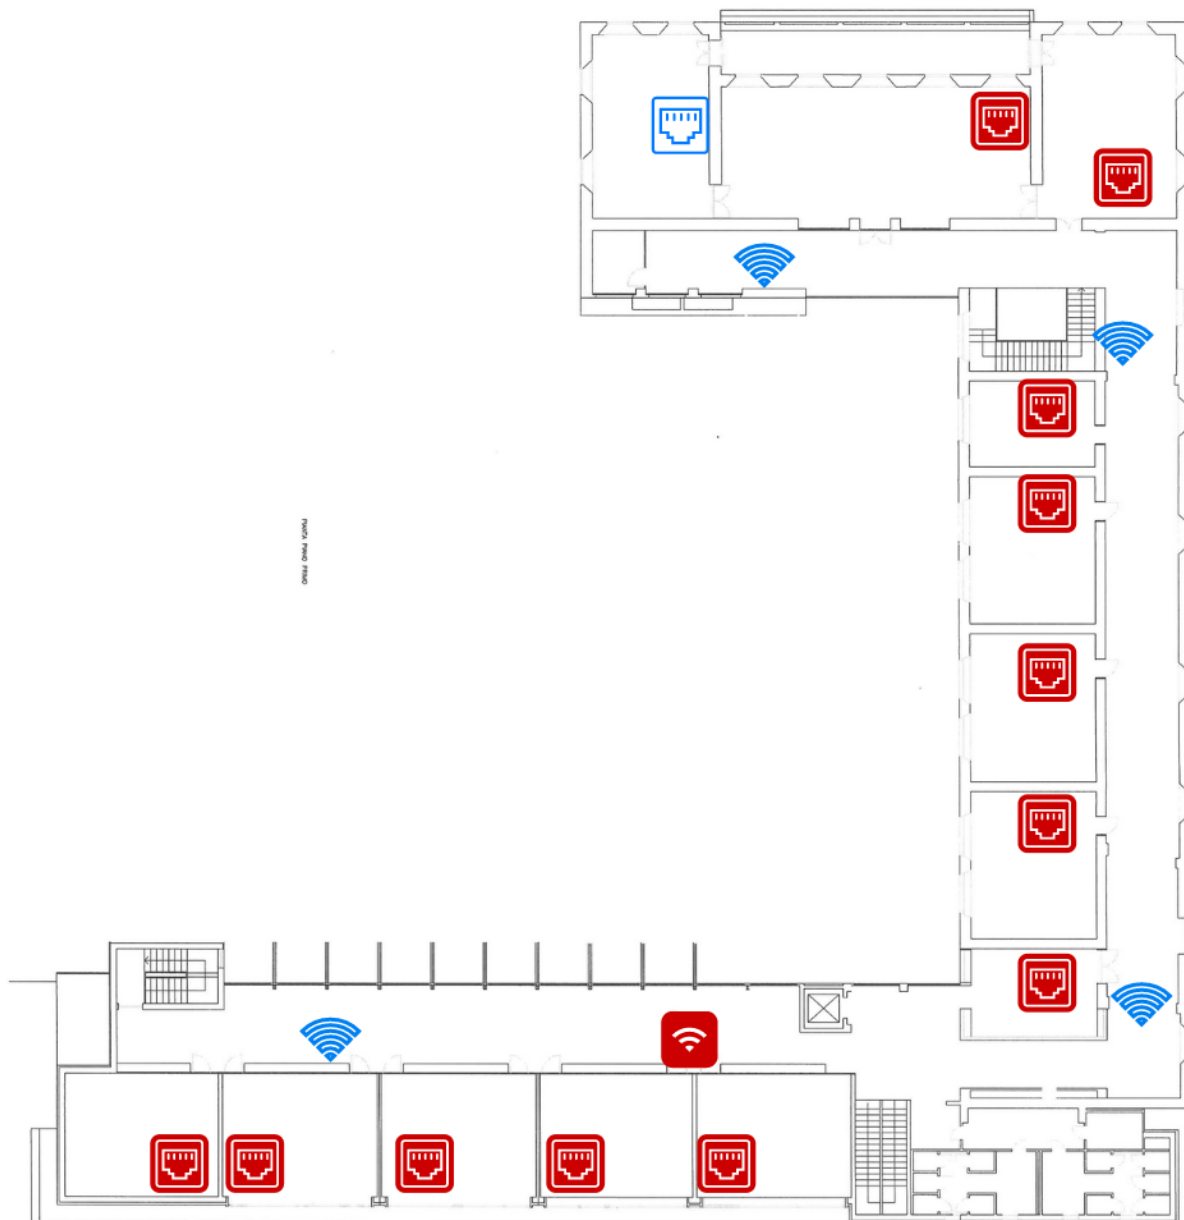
Planimetria Scuola Primaria "V. da Feltre" - Primo piano
